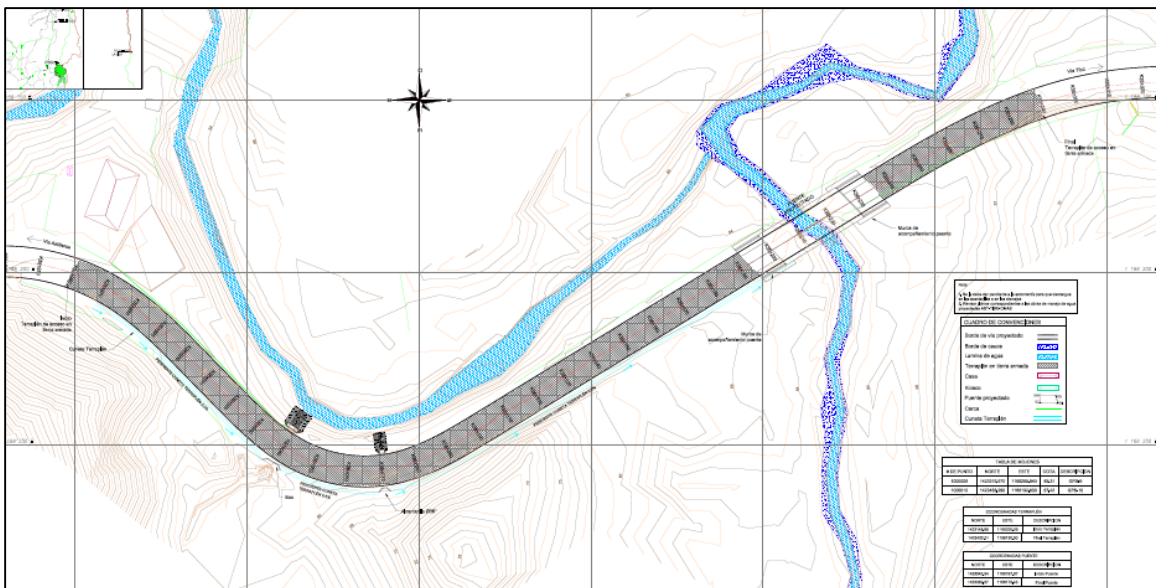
Planta general de localización de proyecto Tramo vial K35 + 910 – K36 + 315 Puente 5, Vía Astilleros – Tibú.
